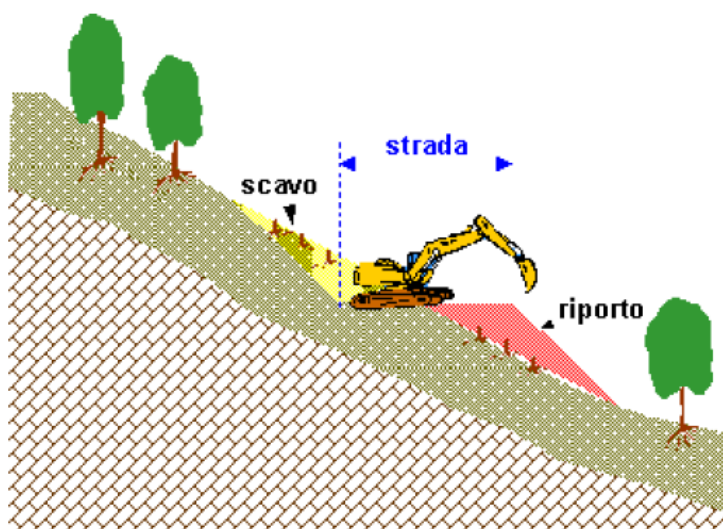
Schema di realizzazione pista di cantiere Tipo II - Compensazione scavo/riporto.
